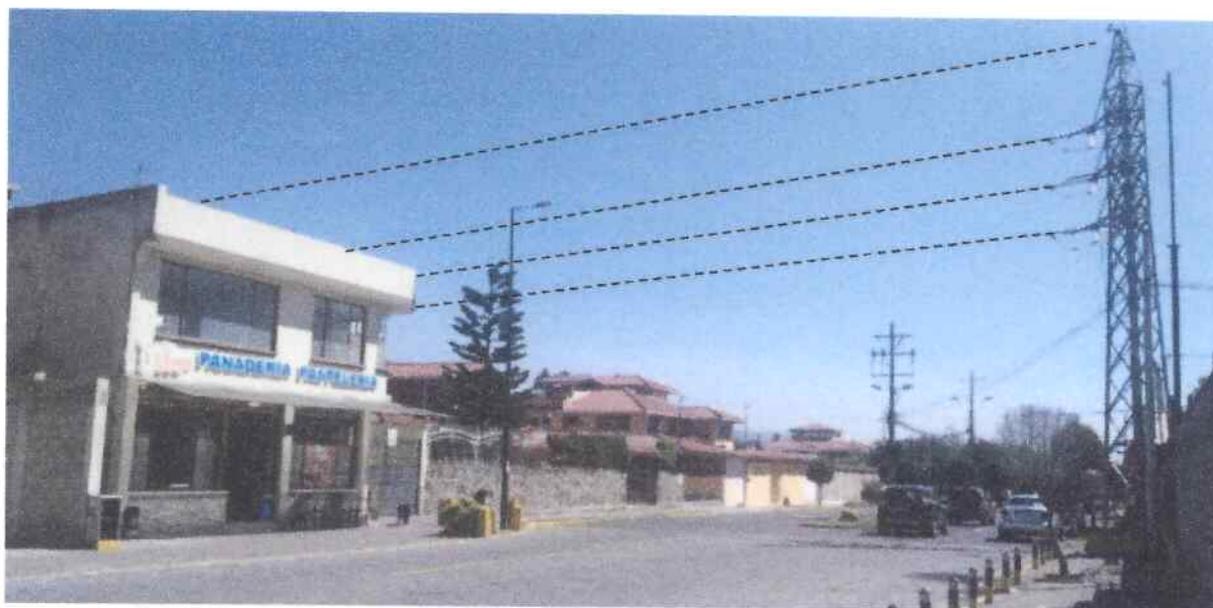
Cables de alta tensión que cruzan por todo el Barrio.
